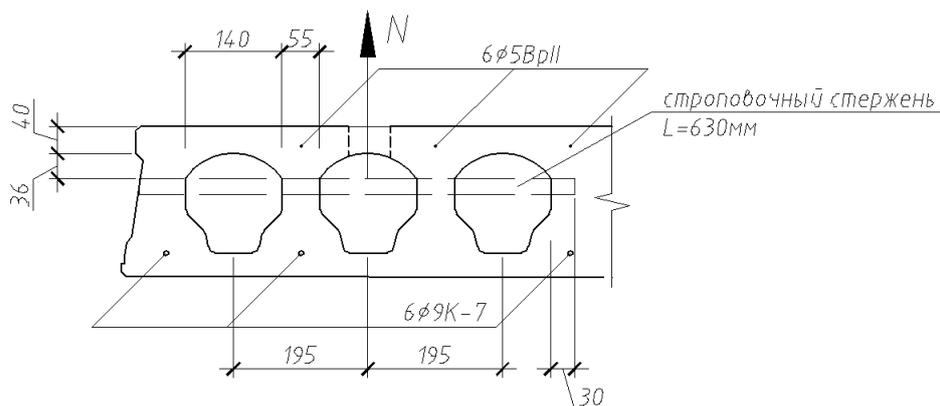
Фрагмент панели в зоне расположения строповочного стержня.
